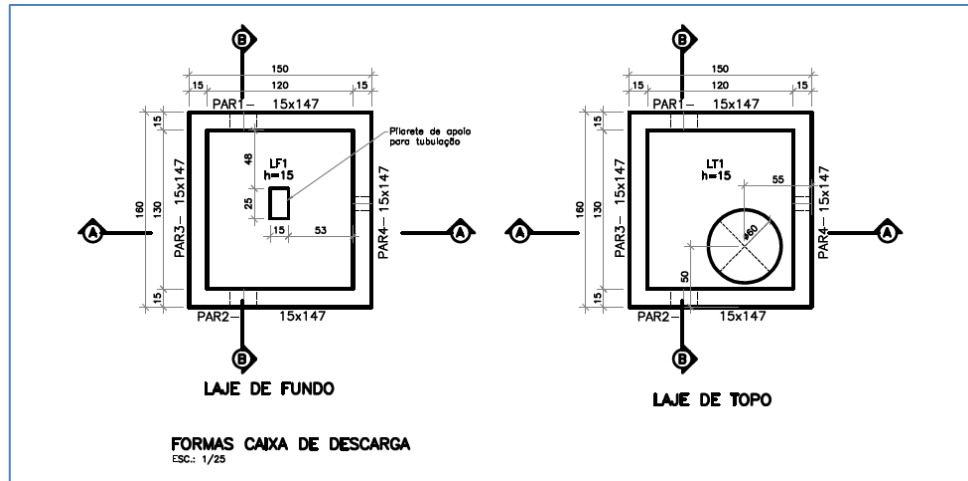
Planta das lajes de fundo e topo da caixa de descarga – EEEB1
